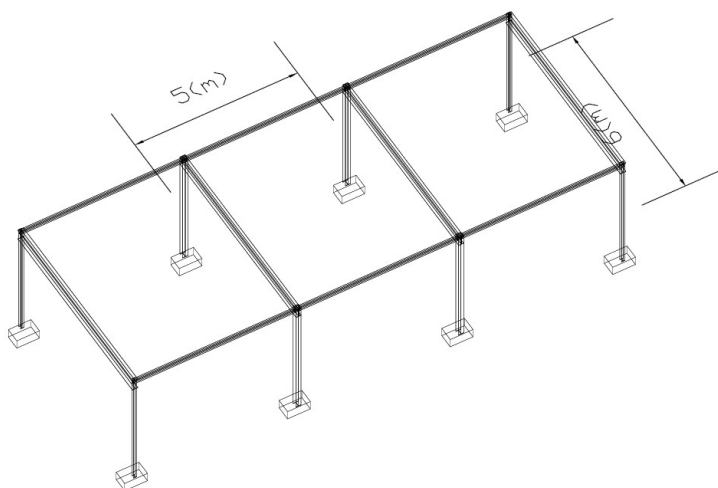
Vista en perspectiva de la estructura metálica del forjado. (Fuente: CypeCad)
